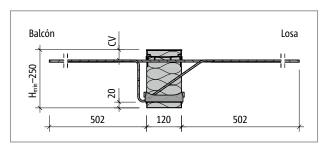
Schöck Isokorb® XT tipo K-M13: Plano del producto
